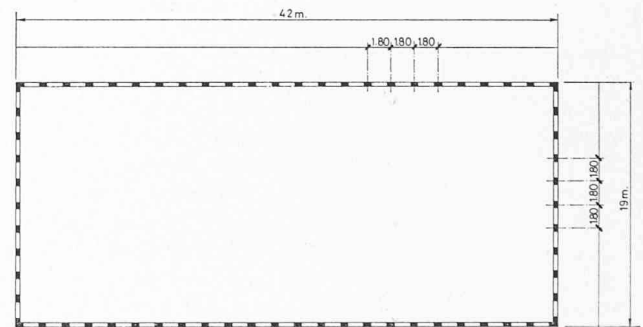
Structure plissée : tuyau. Disposition en plan.
